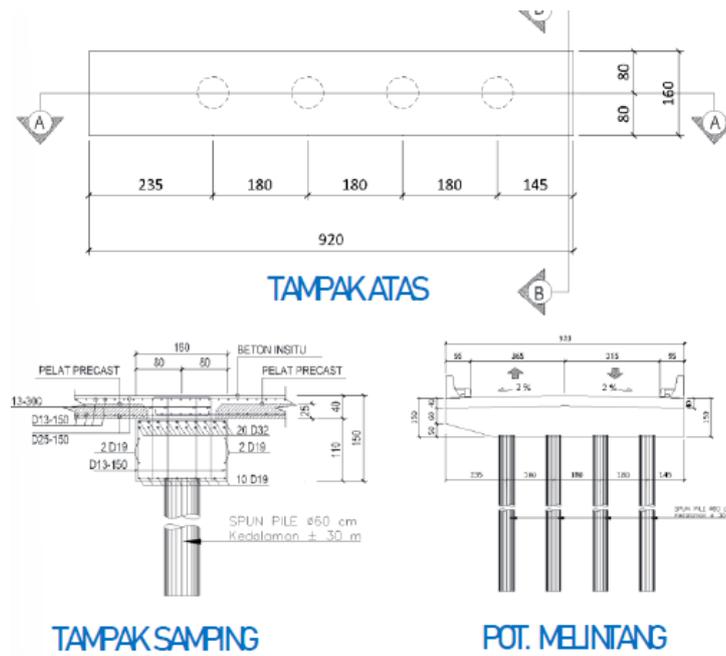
2 Gambar Ilustrasi Tipikal Struktur Timbunan
